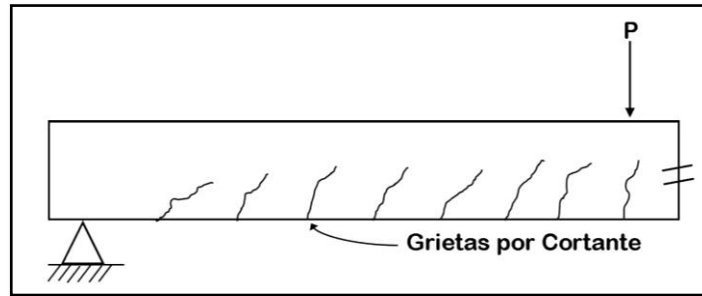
Fallas por Cortante en Vigas de Concreto Armado.
